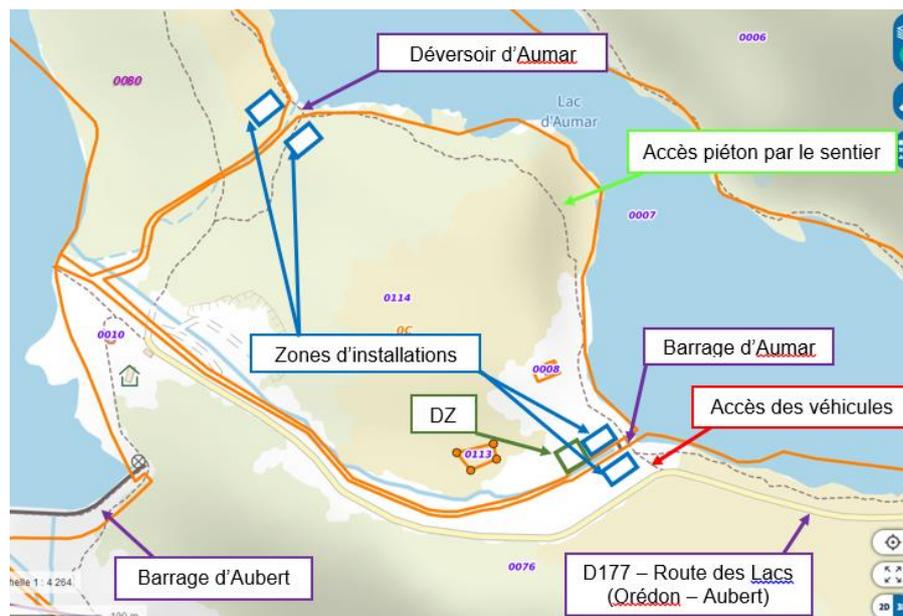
Installation et accès de chantier aux deux zones de travaux
